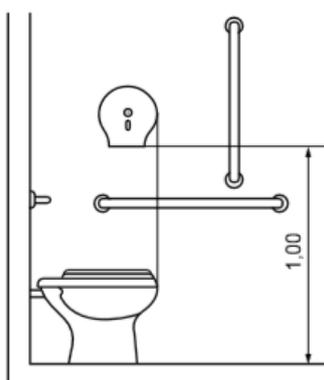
Localização da papeladeira de sobrepôr (rolo) – Vista lateral
